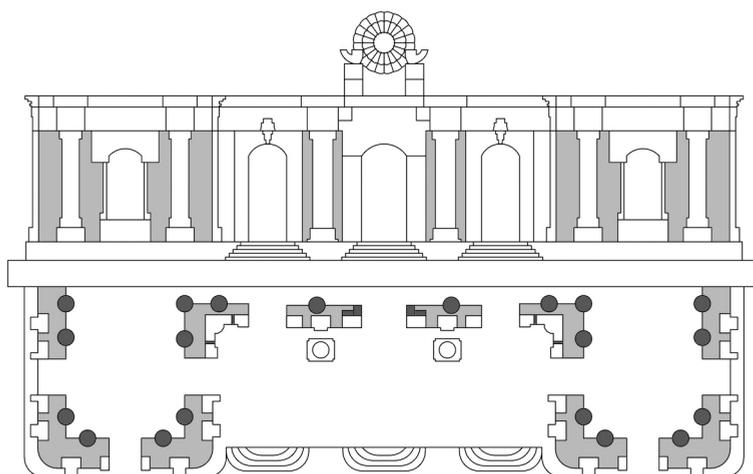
Reconstrucción de plano de la fachada Sur del Yuanying Guan. Reproducción del autor.
